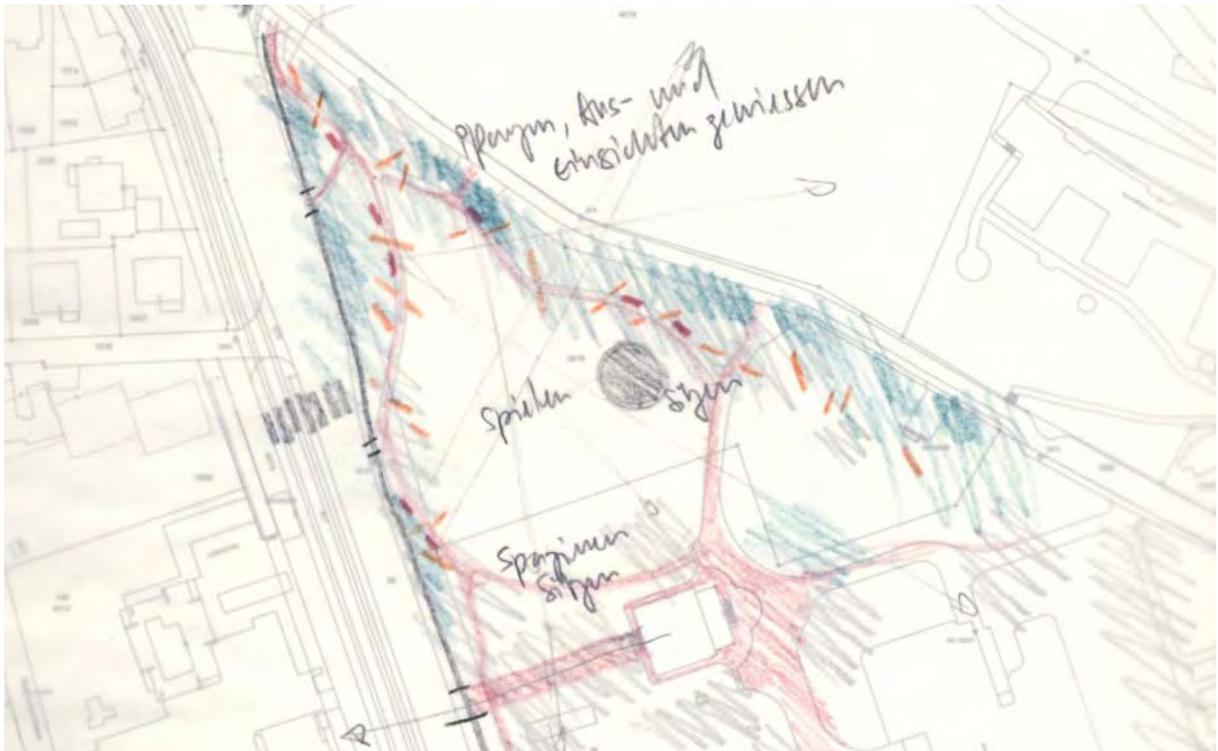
Grundriss: Aufwertung des Ehinger Parks, Münchenstein - Idee
